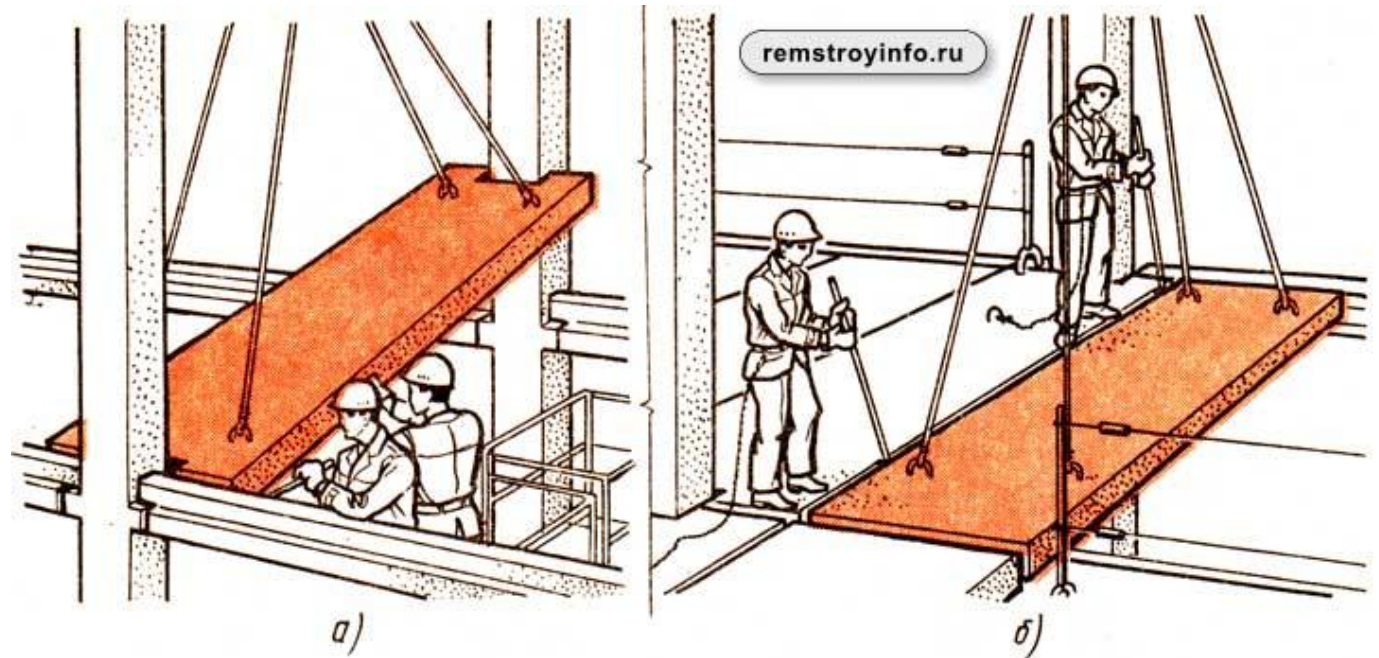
Укладка связевой (распорной) (а) и рядовой (б) плит перекрытия
